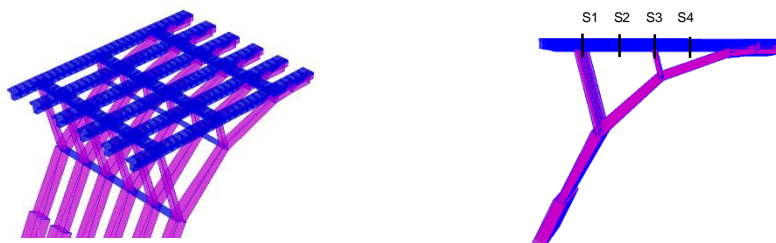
Vista 3D das secções de controlo: apoio das vigas na ligação aos montantes e meio vão correspondente
